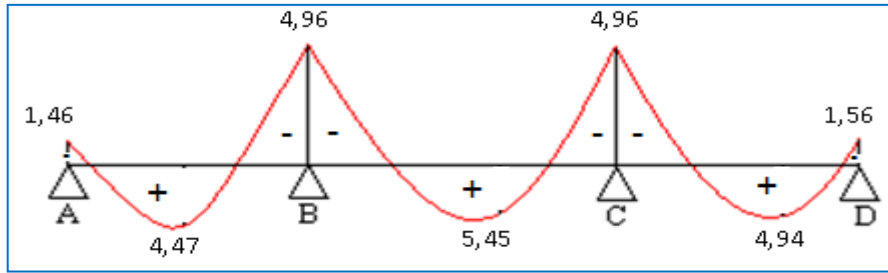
Diagramme des moments en ELU (poutrelle type 01 – plancher terrasse)
